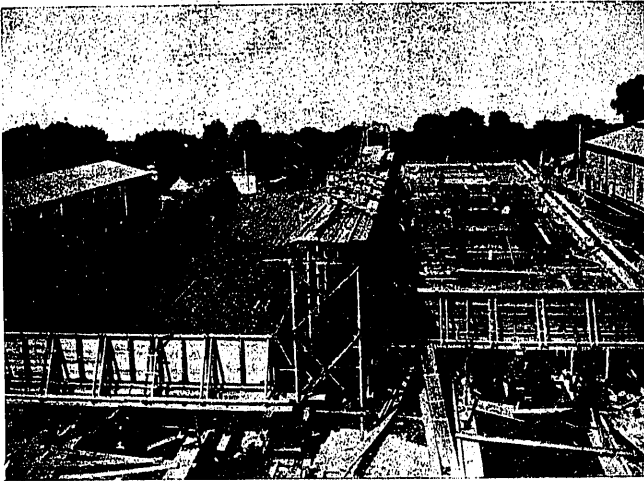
Dos embarcaderos flotantes en su grada de construcción.
